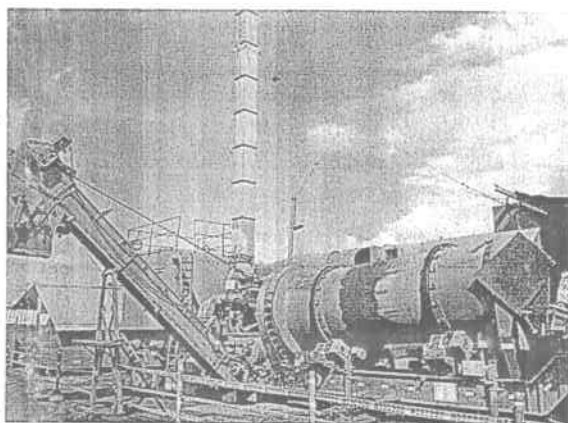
Planta Asfáltica Obras Especiales - ASSA, Grupo Constructor S.A.S.
